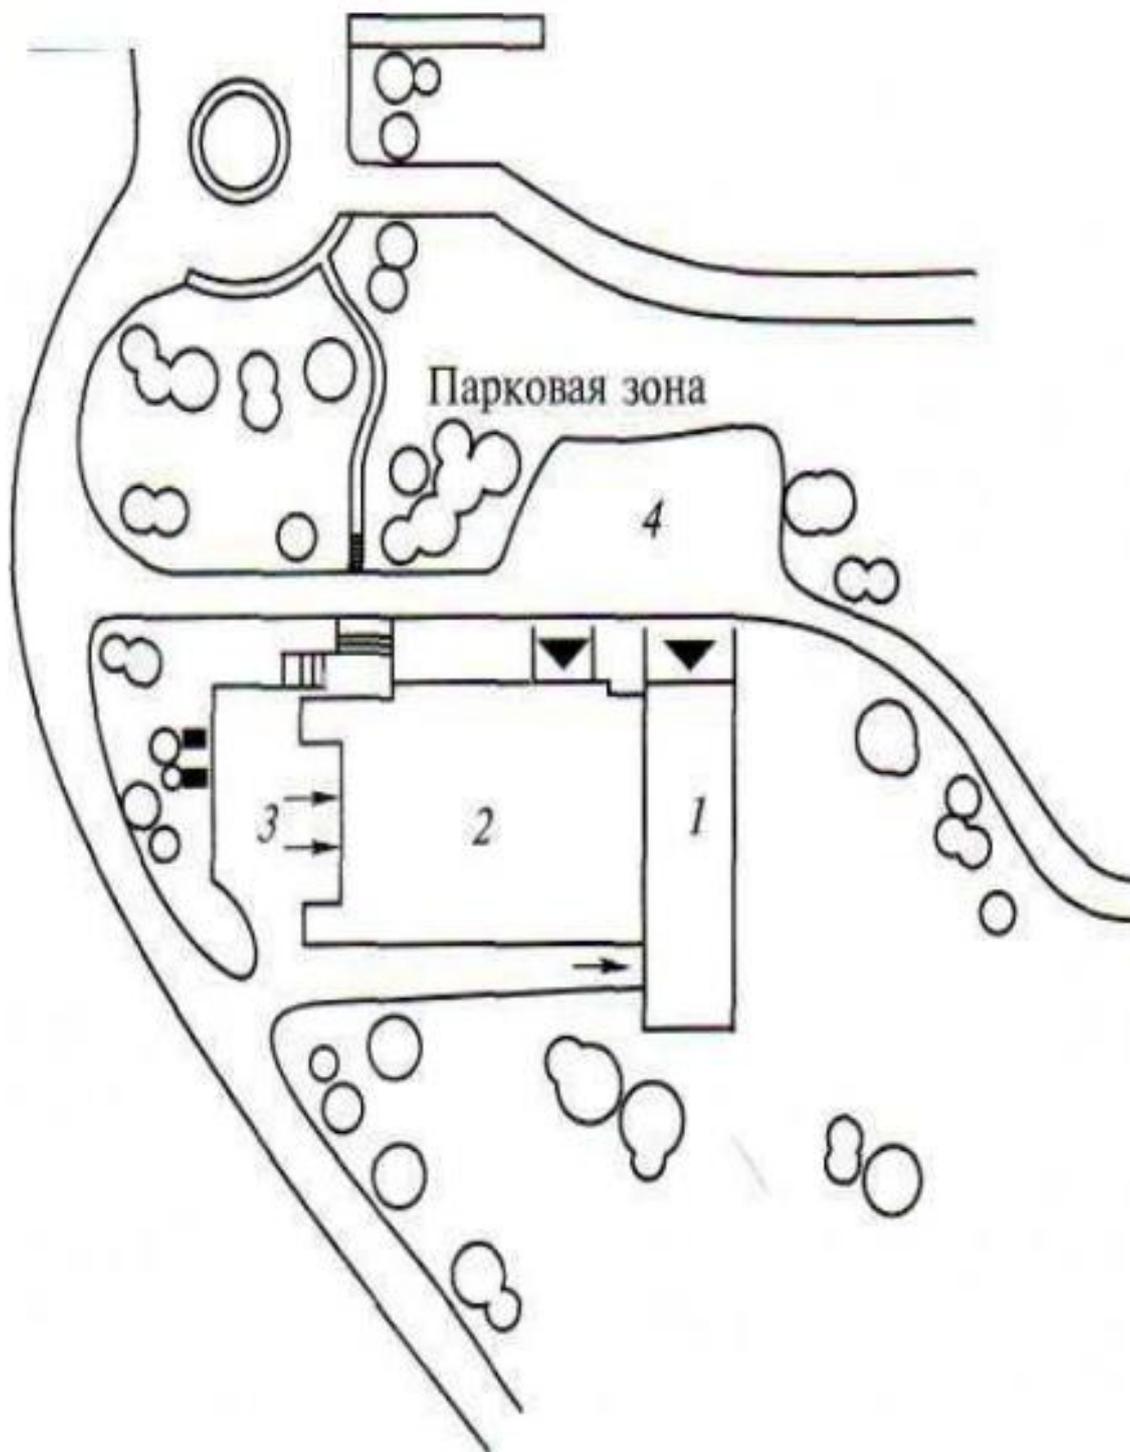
Генеральный план городской гостиницы: 1 — жилой корпус; 2 — ресторан и клуб; 3 — хозяйственный двор; 4 — автомобильная стоянка у главного входа; ^ — главный вход; -* — служебный вход.
